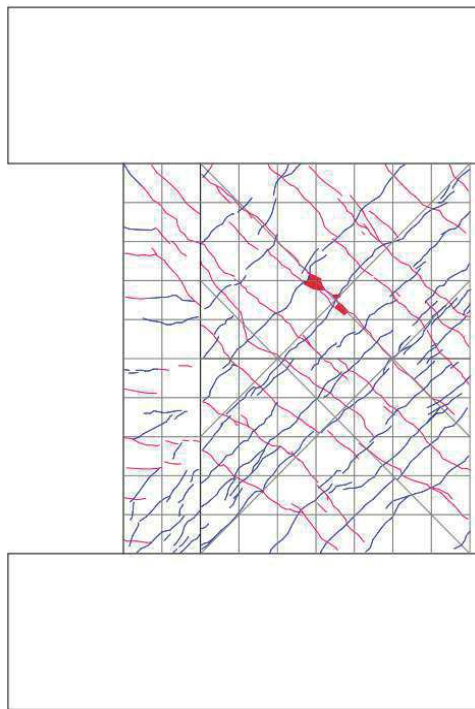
試験体 S-06-DIV 事前加力終了時 (6/1000rad.) ひび割れ図
